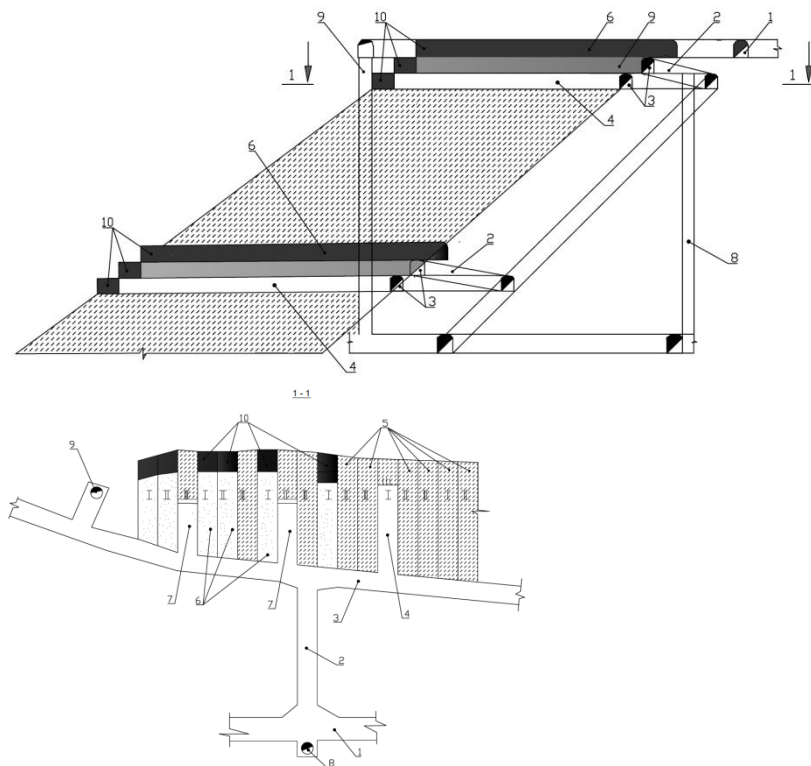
Горизонтальная нисходящая слоевая система разработки с закладкой выработанного пространства под перекрытием искусственного перекрытия
